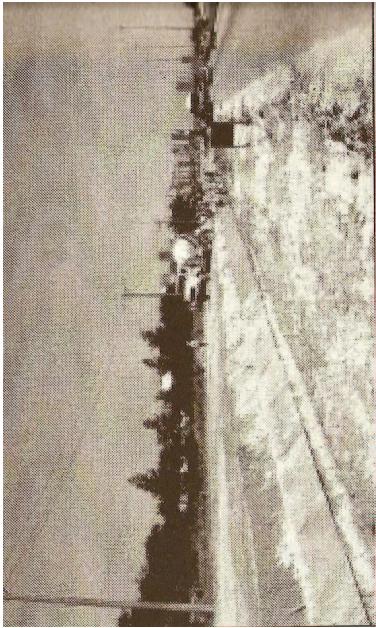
Início da duplicação da avenida Ayrton Senna. 1995
